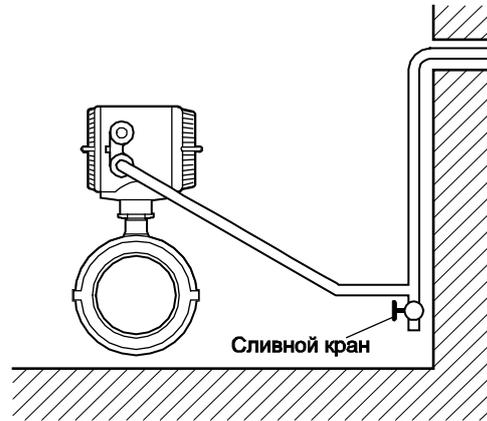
Прокладка электропроводки в кабелепроводе
